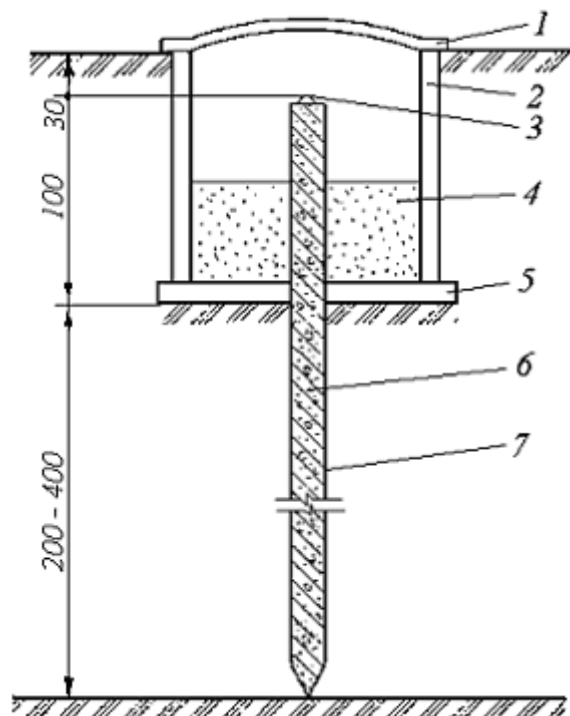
Грунтовой свайный репер, устанавливаемый забивкой или в котловане ниже глубины промерзания на 1–2 м:
